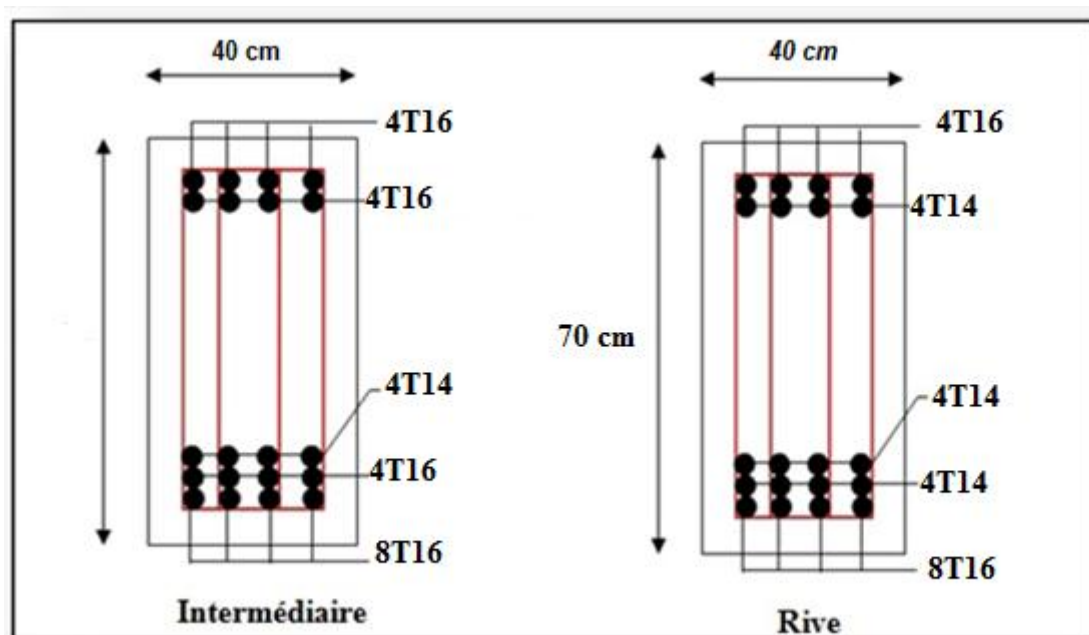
Ferrailage de la poutre de libage suivant le sens transversale.
